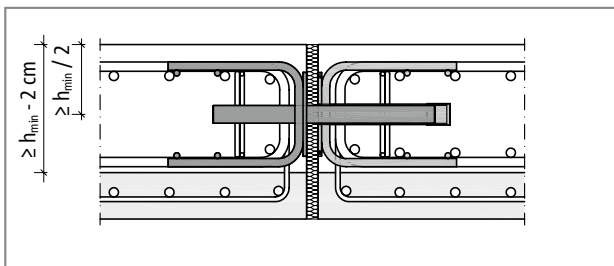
Schöck Dorn Typ SLD: Bauseitige Bewehrung bei Elementdecke
